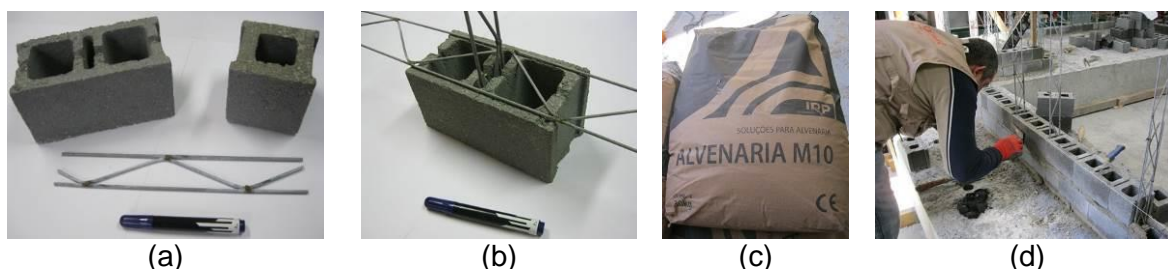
Materiais utilizados na construção dos modelos à escala reduzida: (a) bloco, meio-bloco e armadura, (b) disposição dos blocos e as armaduras, (c) argamassa pré-doseada e (d) construção do modelo reforçado.
